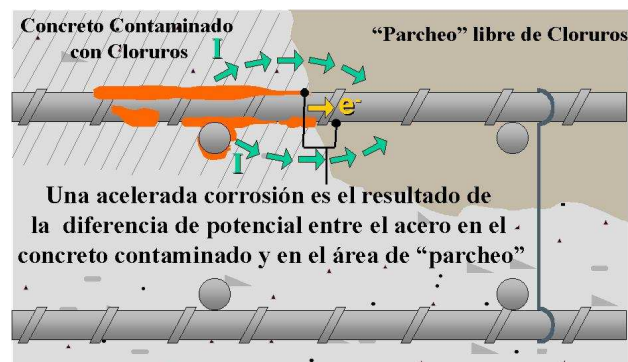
Corrosión del acero embebido en un hormigón contaminado con cloruros próximo a una zona reparada
